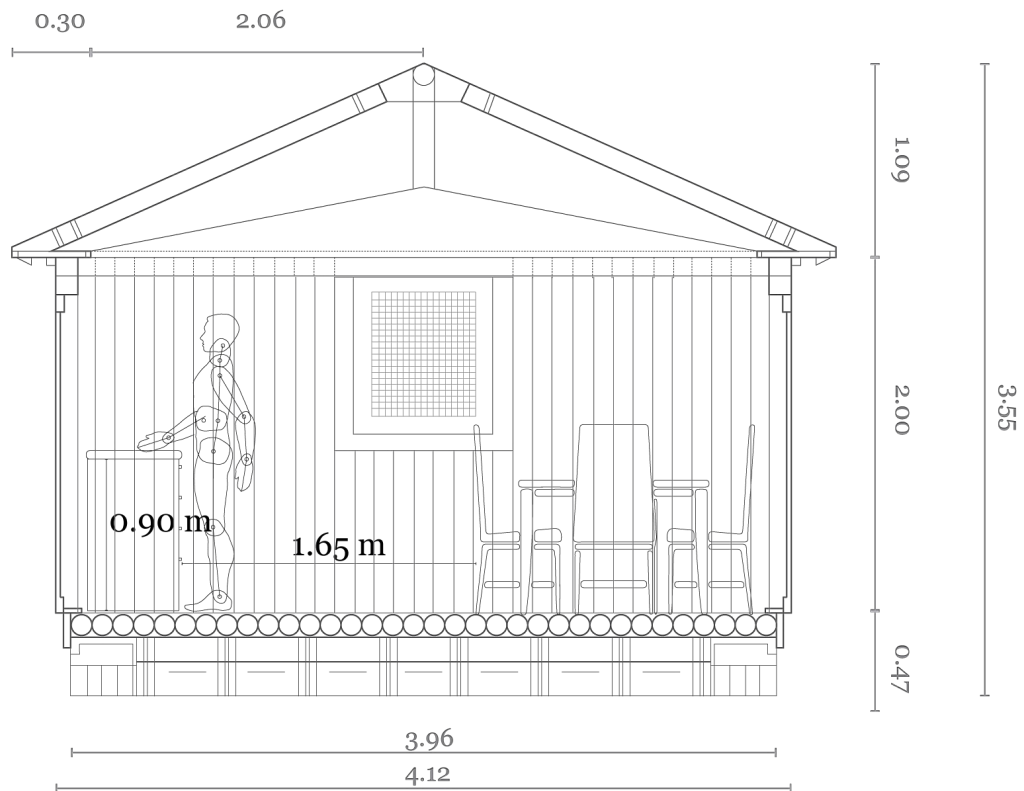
Sección B-B del Paper Log House. Elaboración: Autores. Escala 1:50
